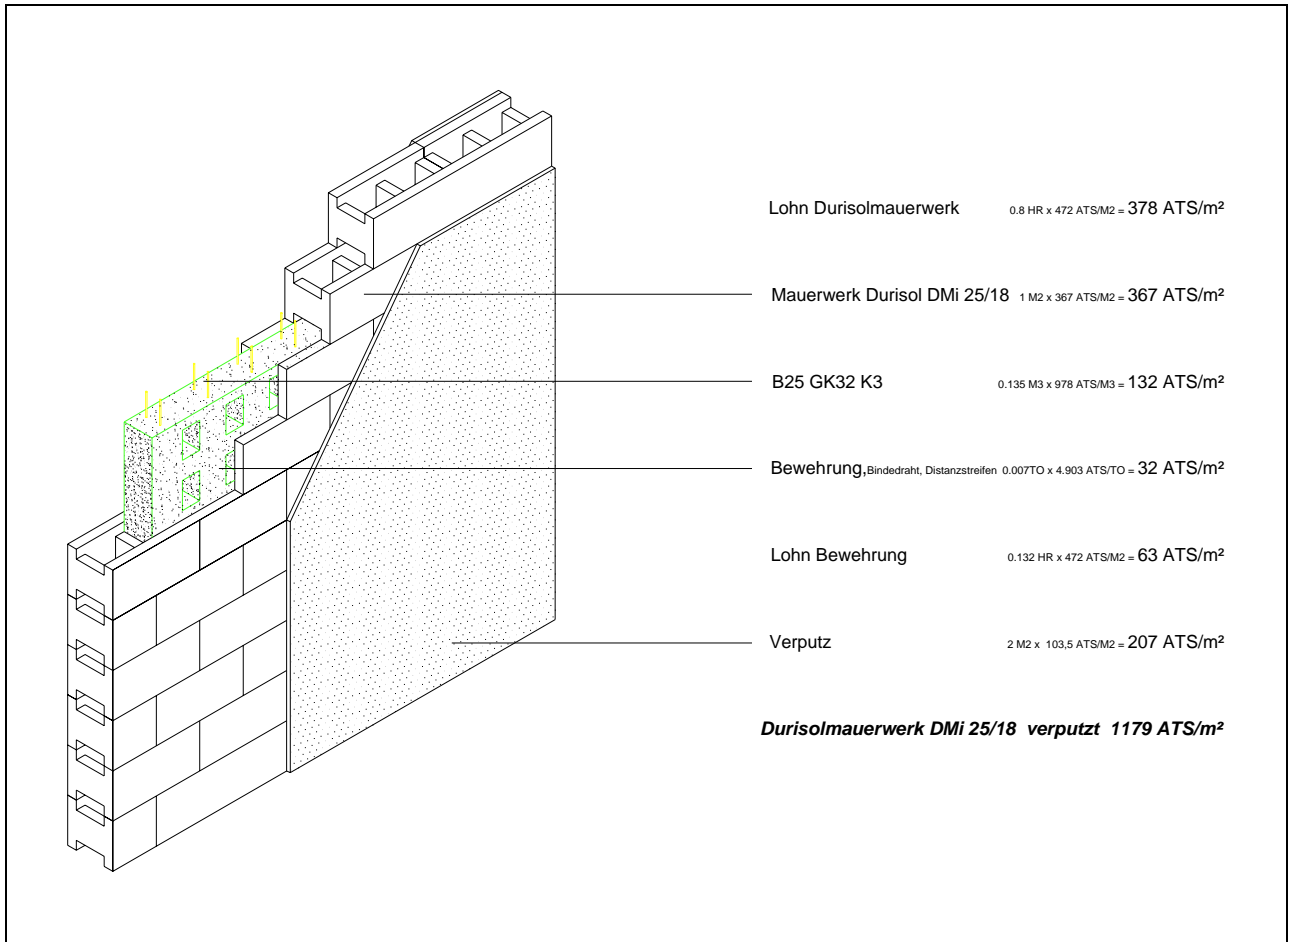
Mantelbetonmauerwerk (BW2)
